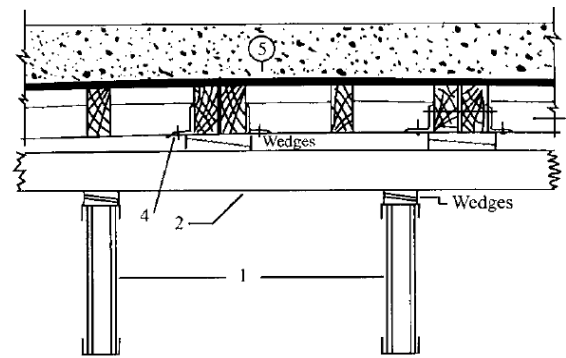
Detalle del Encofrado de la Hoja de Entrada
